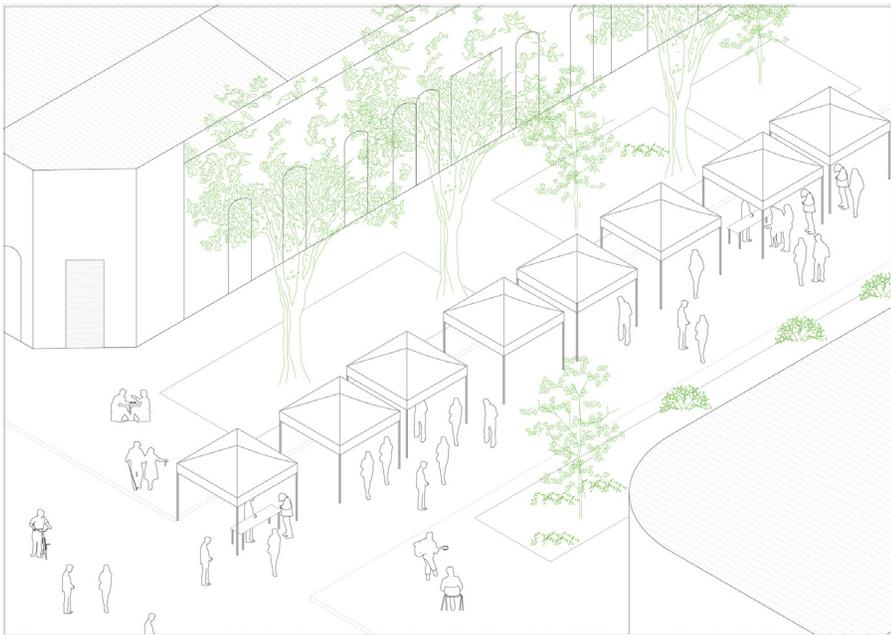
Levantamiento feria de oficios en escala de la cuadra. Elaboración propia.
